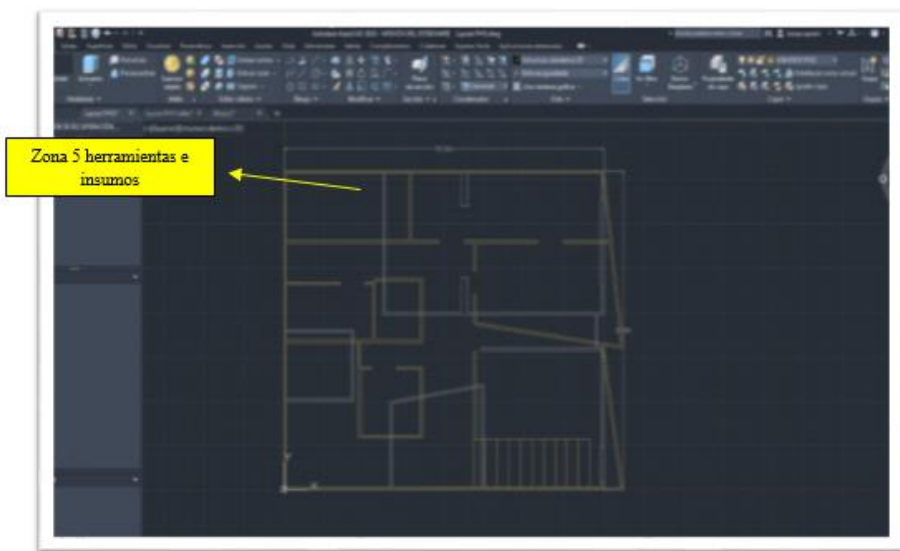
Plano del Layout actual Primer piso Planta PHIS S.A.S
